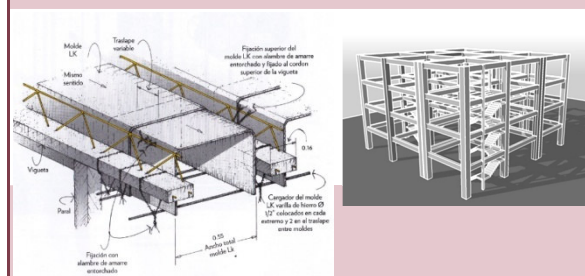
Molde LK. Fuente: Revista Precon, 2014
